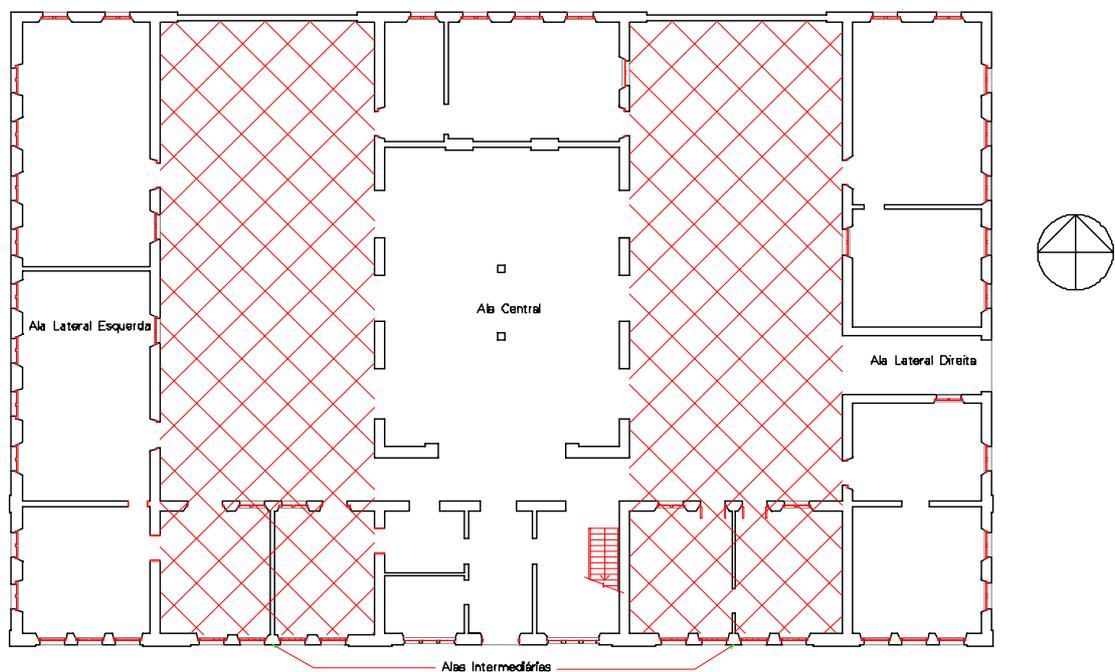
Esquema da divisão em partes da Planta Baixa do Térreo.
